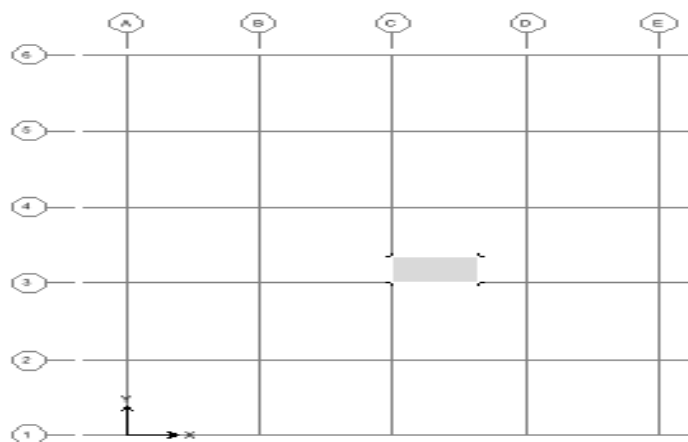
Vue en plan de la dalle d'ascenseur
